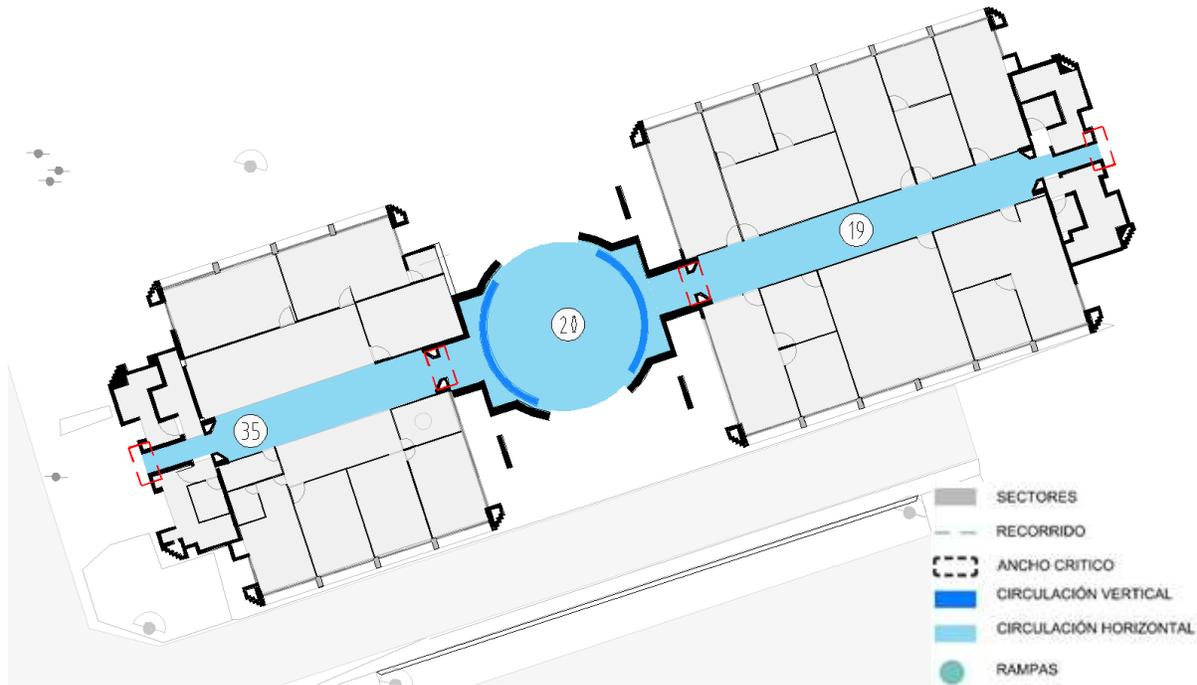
Planta esquemática de circulaciones Bloque No.76
